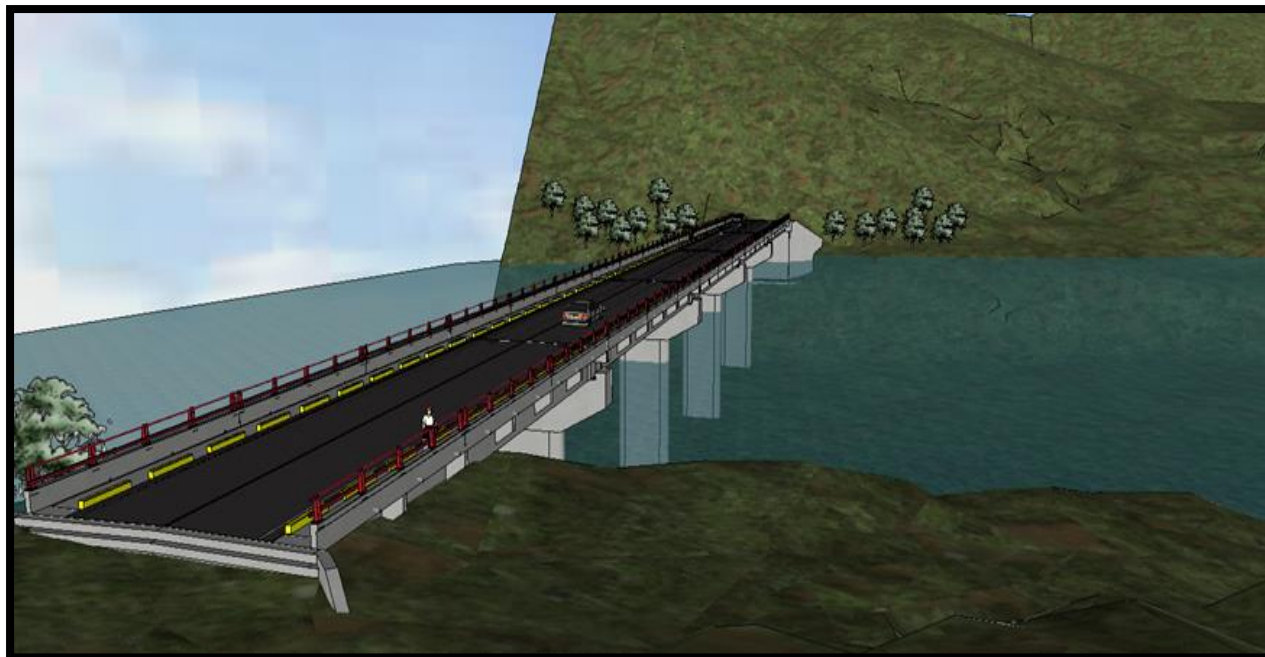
puente Telpaneca, Orientación sur de pilas
